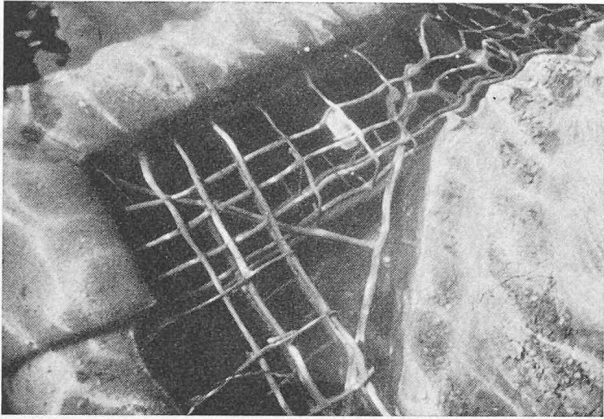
Avant-bec de pile en cours de renforcement, le coffrage constitué par des sacs de béton est bien visible ainsi que le ferrailage.
